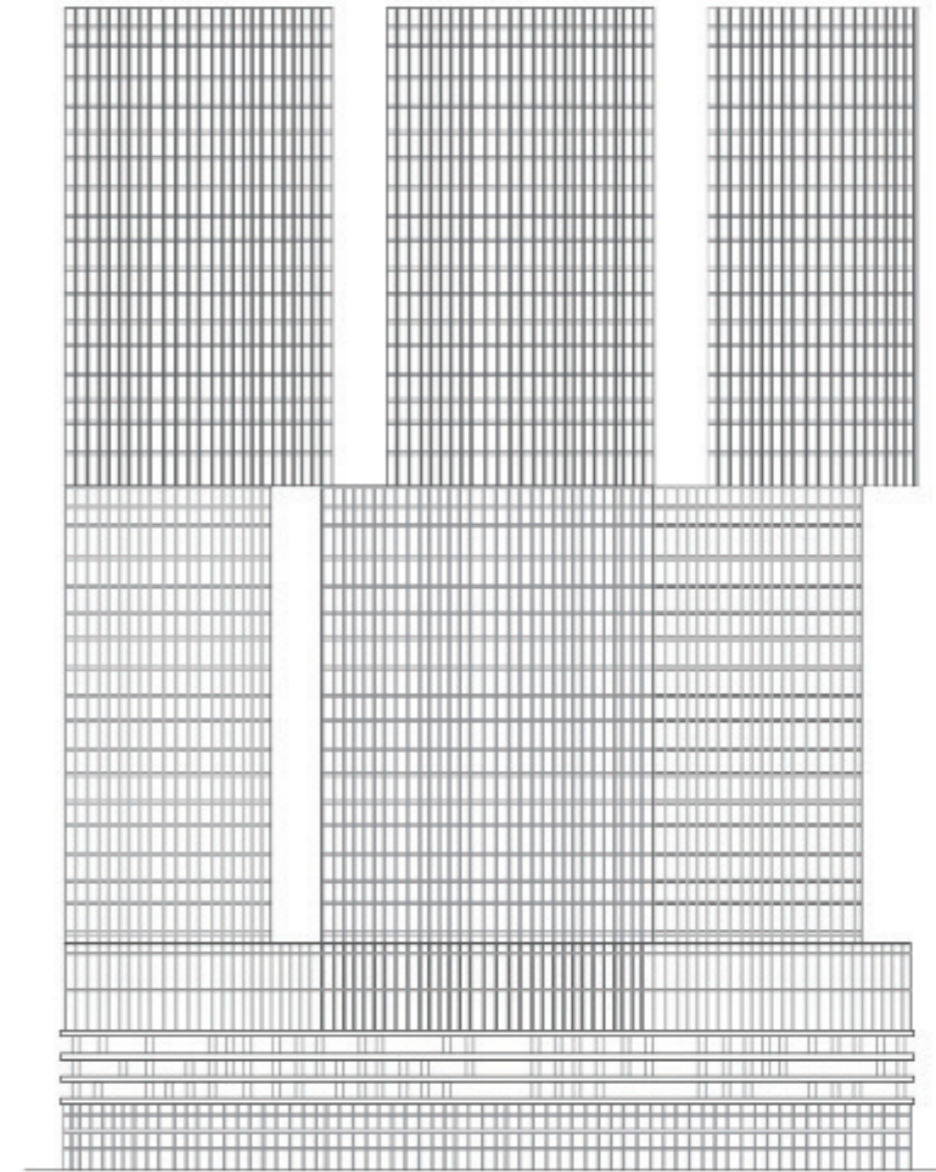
Alzado del edificio De Rotterdam. Plano realizado por el autor basados en los dibujos del edificio.
